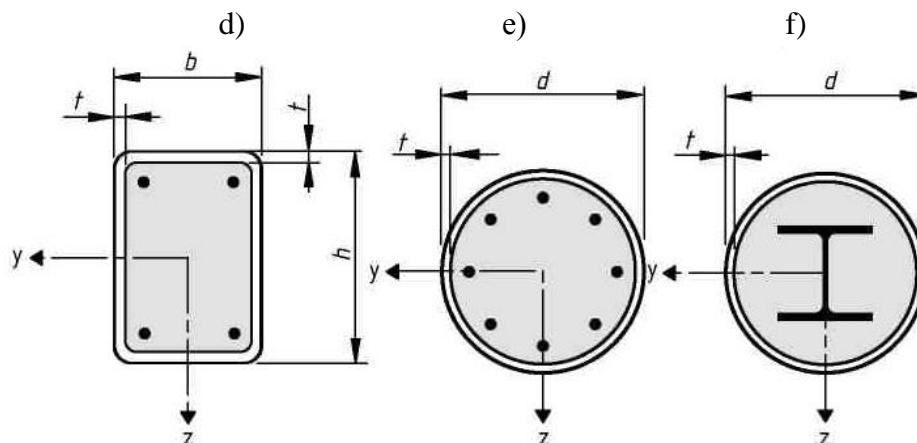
Виды и геометрические параметры поперечные сечений сталежелезобетонных колонн
